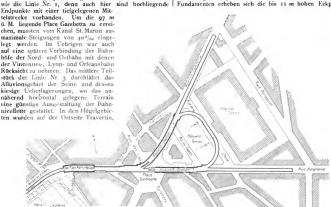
Endstation unter der Place Gambetta. - Lageplan. - Masstab 1:5000.
